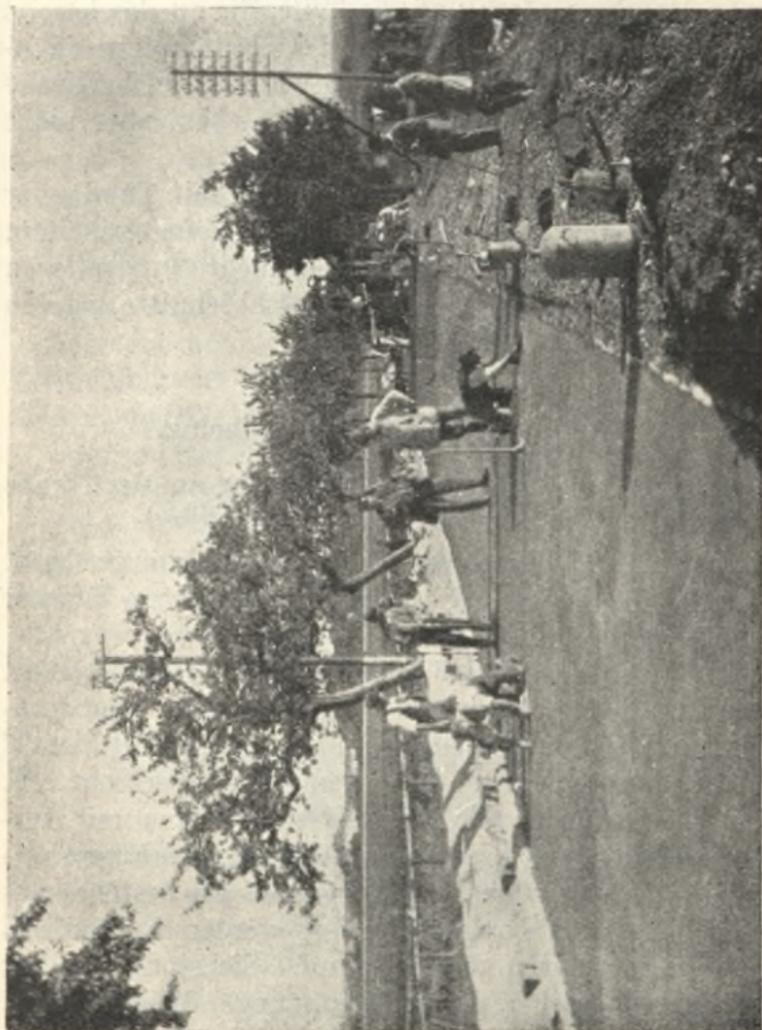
Rhoubenite-Betonstraße in Erfurt. Nachstampfen und Abreiben der Oberfläche.
